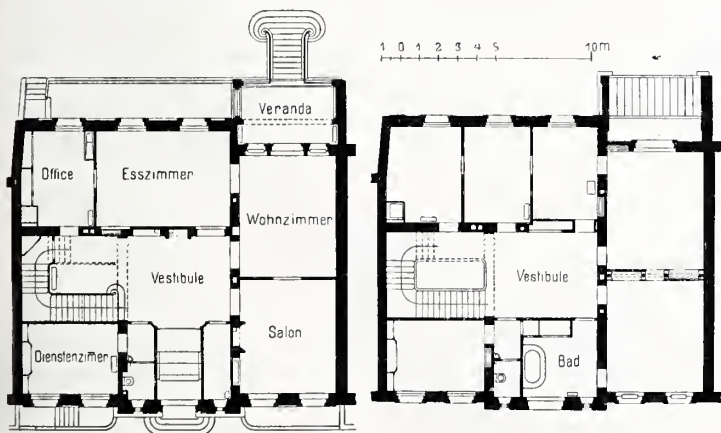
und 25. Grundrisse des Familienhauses an der Hartstrasse.
